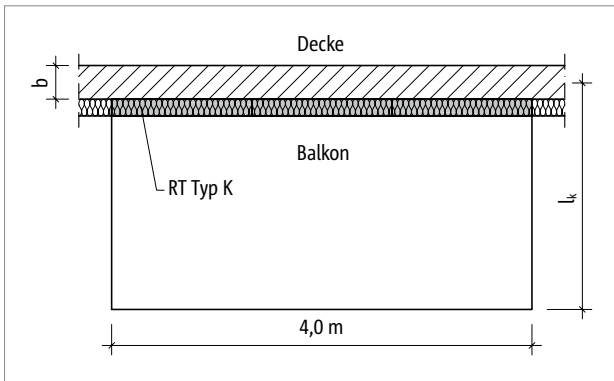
Schöck Isokorb® RT Typ K: Grundriss
